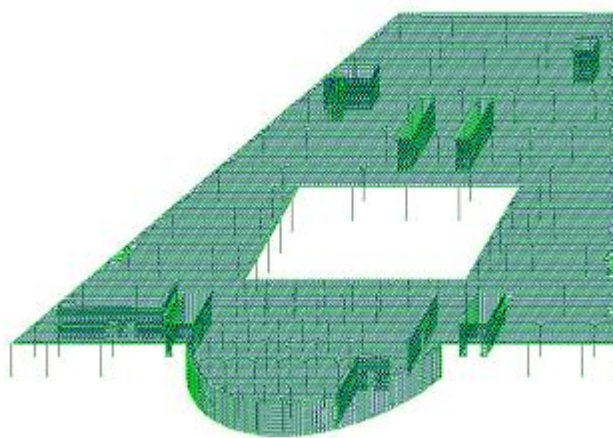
Расчетная схемы плиты перекрытия. Общий вид
